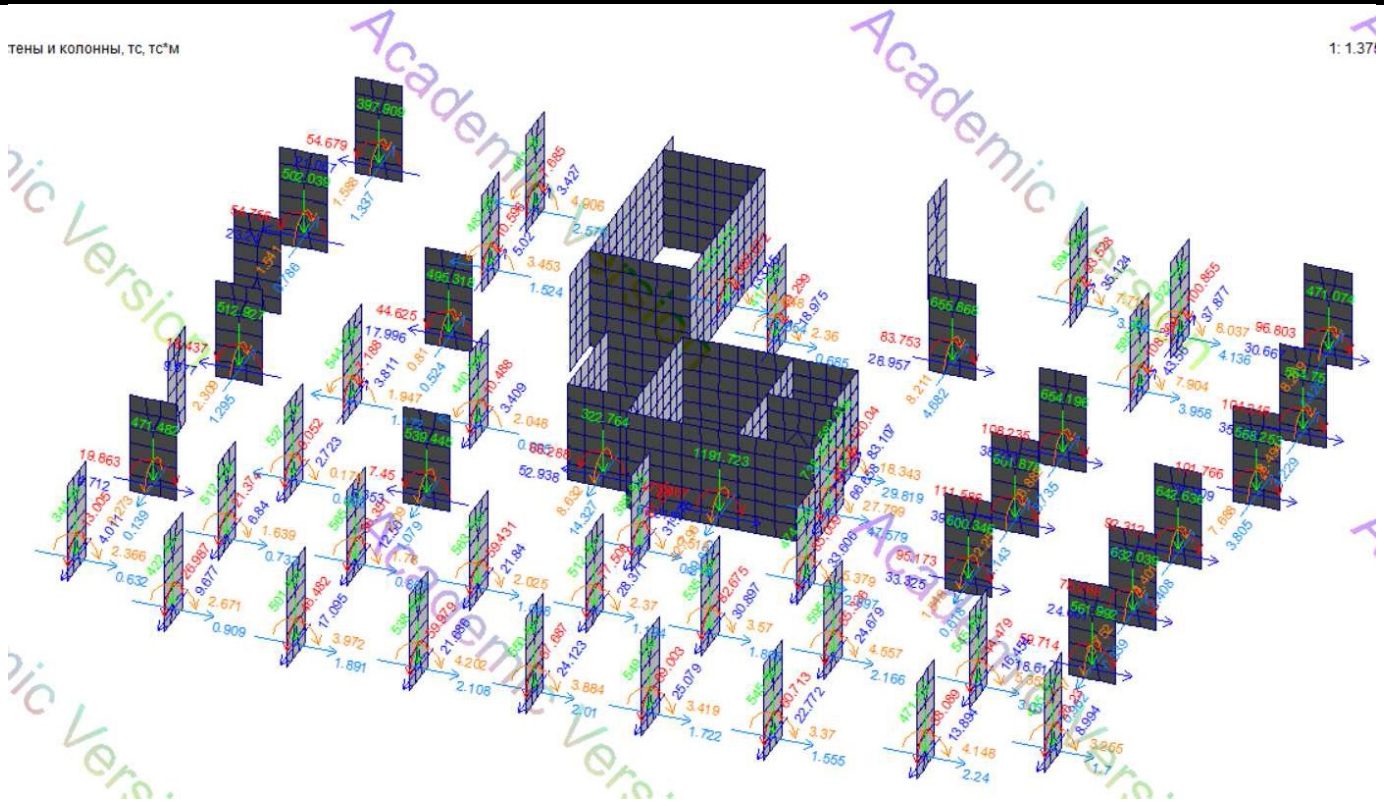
Навантаження на верхньому обрізі фундаменту будинку в ЖК «Атлант».
